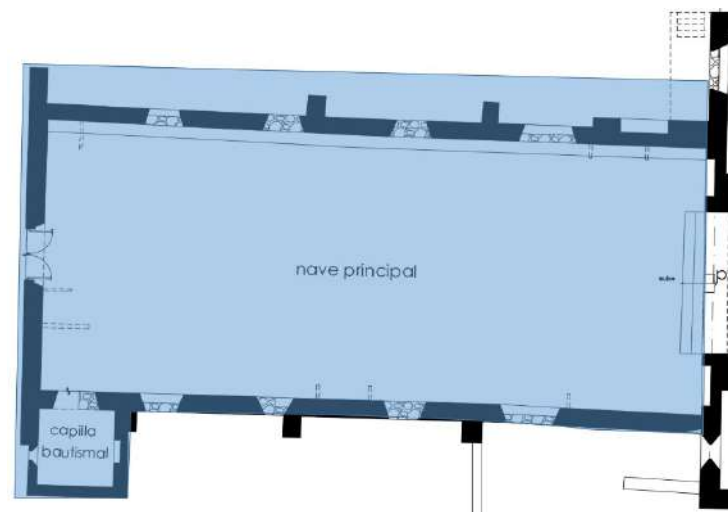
Nave principal con capilla bautismal al sur y evidencias que indican la presencia de un coro de madera. Fuente: Elaboración propia
